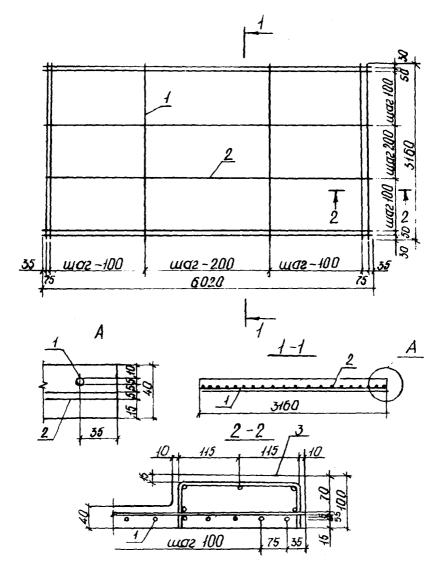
Армирование предварительно напряженной гибкой пластины напряженная проводока поперечная: 2-то же, продольная; 3-утолшение гибкой пластины у ендовы
